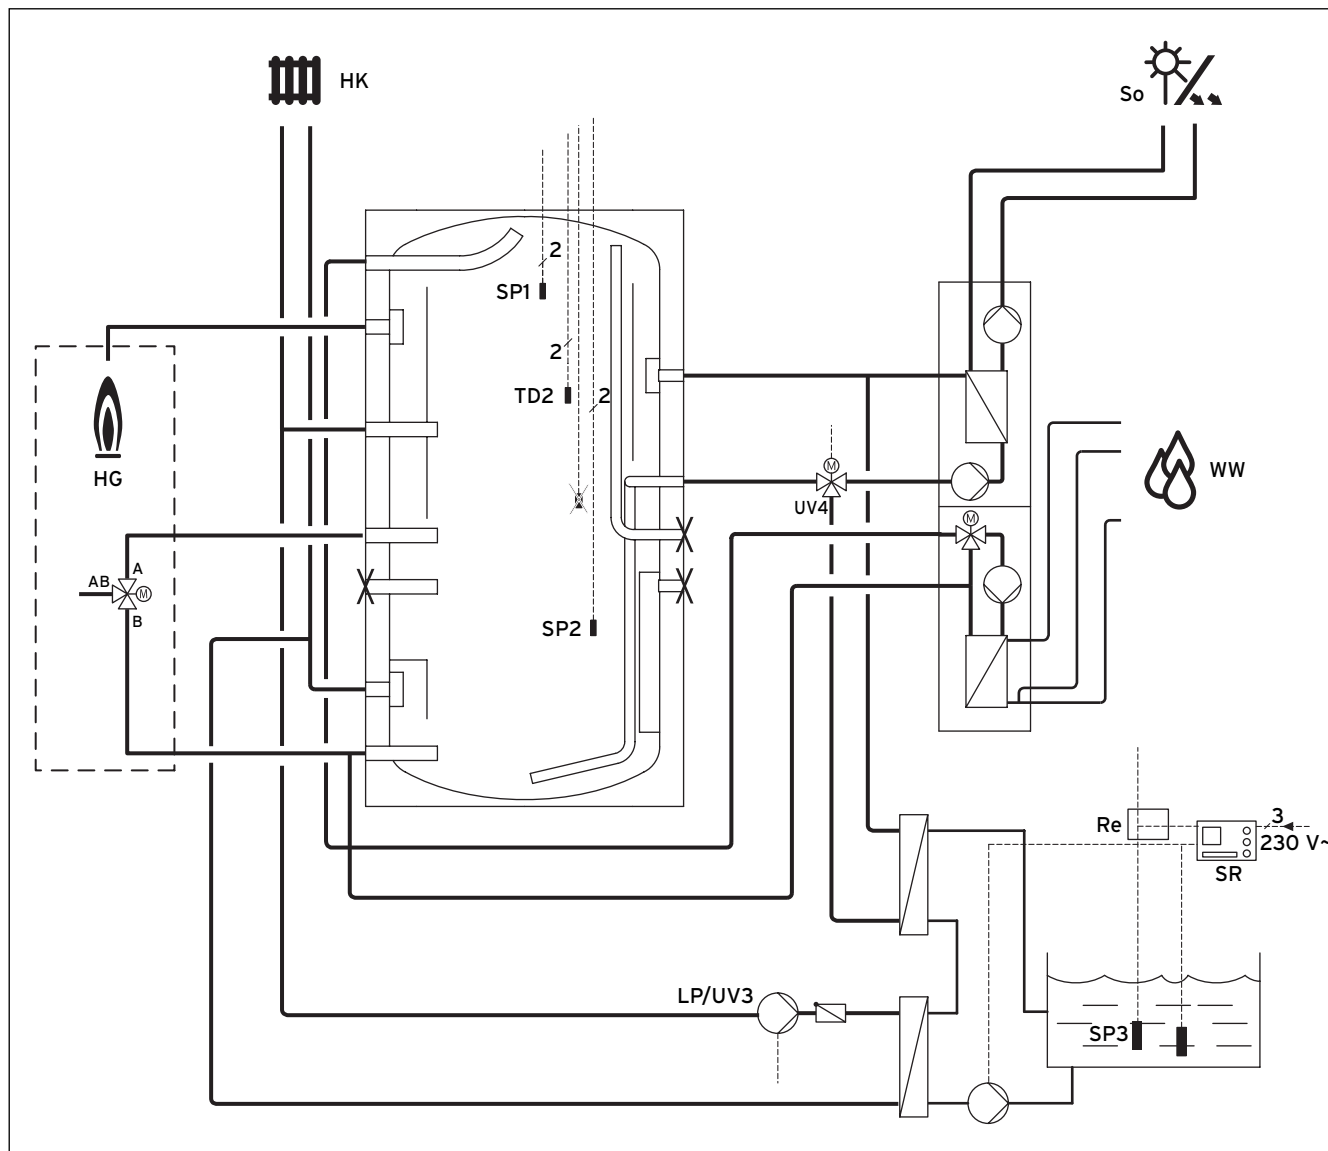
Detailplan Swimmingpoolopvarmning
